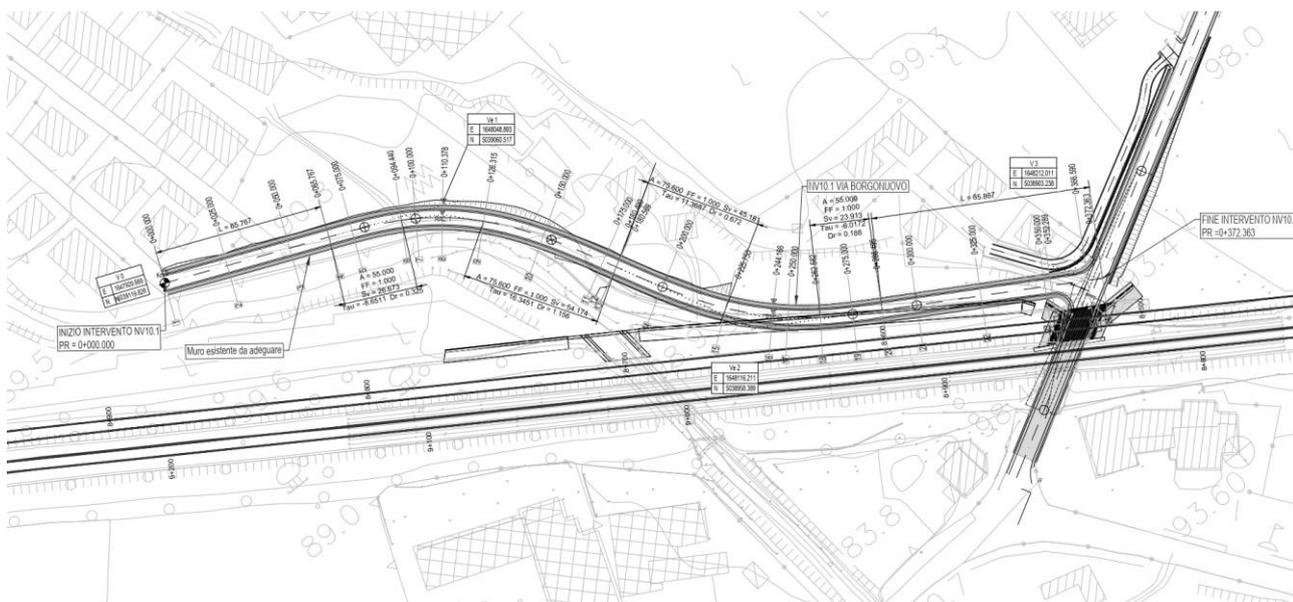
NV10 – Stralcio planimetrico su rilievo di Via Borgonuovo
